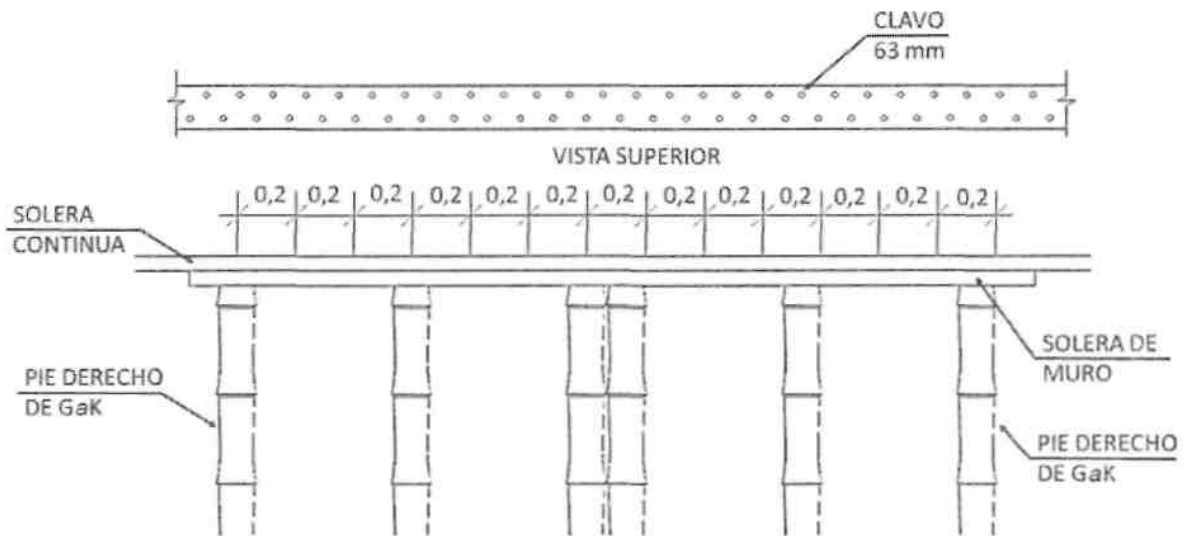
Paneles con estructuras de GaK y madera. Vista superior.
